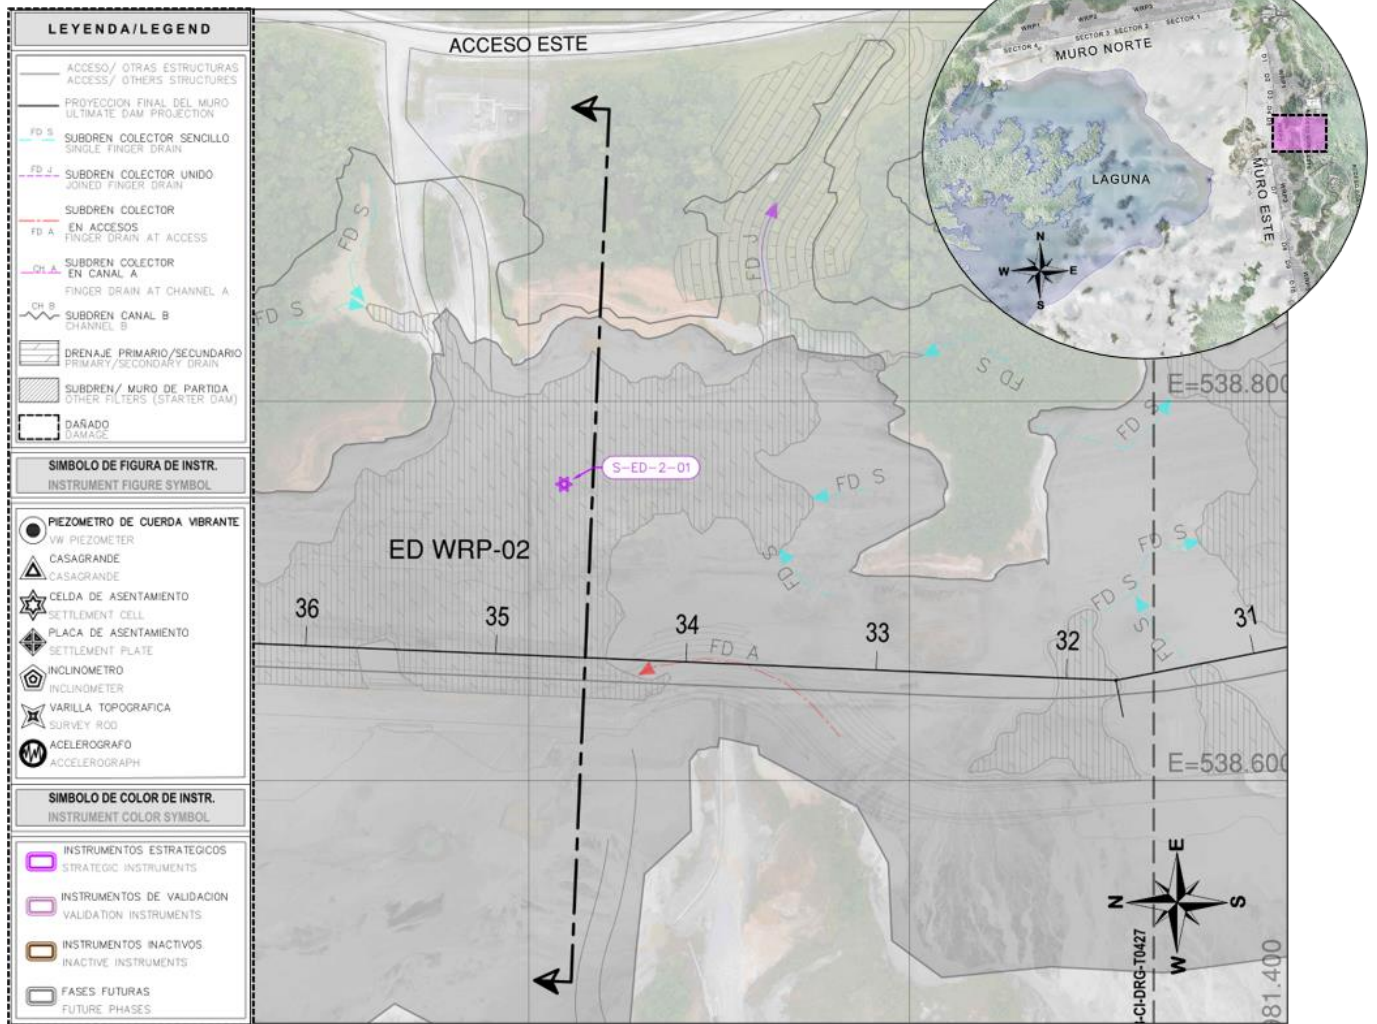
Vista de Planta en el Muro Este WRP2 con las Celdas de Asentamiento
